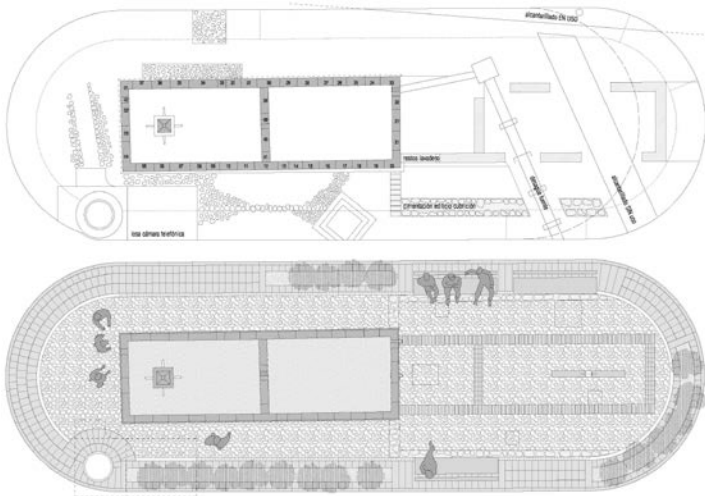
Comparativa planimétrica de la excavación arqueológica y la imagen final de la Restauración.
